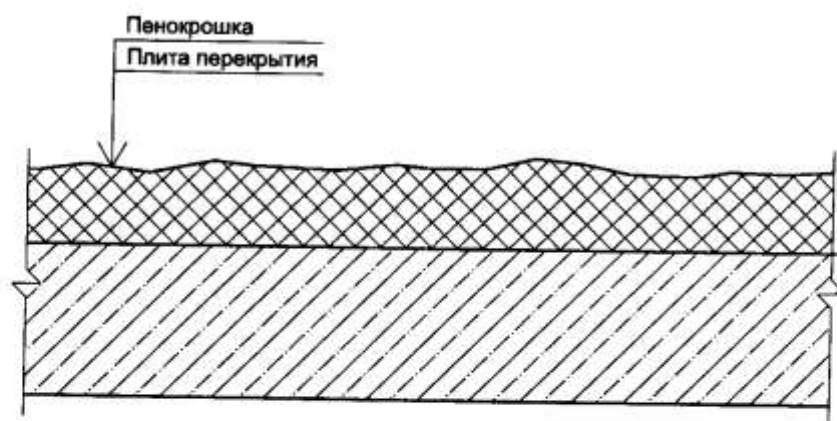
Тепловая изоляция эксплуатируемого чердачного перекрытия
